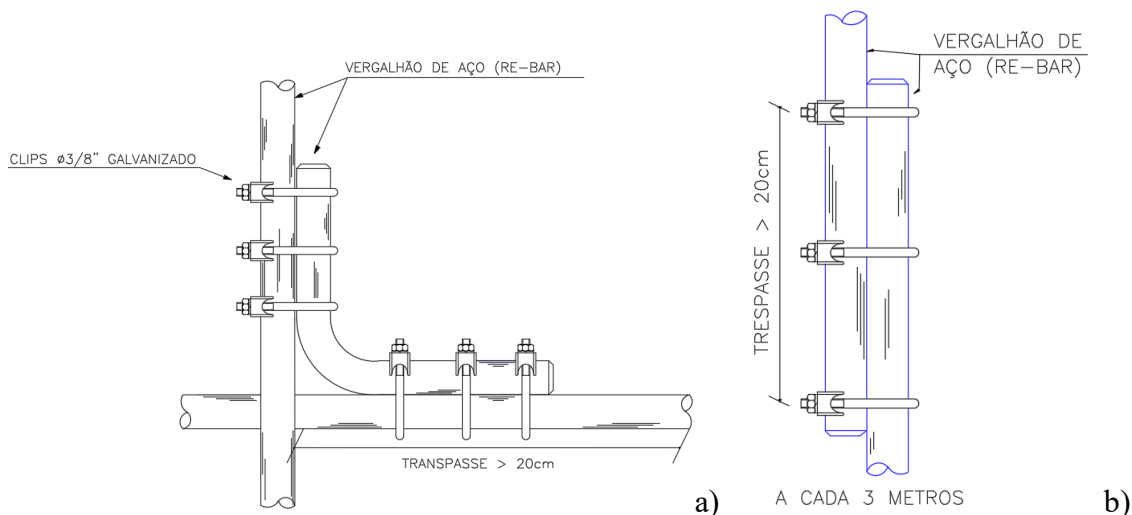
Emenda entre RE-BARS. a) Interligação no cruzamento de RE BAR de Ø8mm (#50mm²) e RE BAR de Ø10mm (#80mm²). b) Interligação de RE BARS sem cruzamento.
